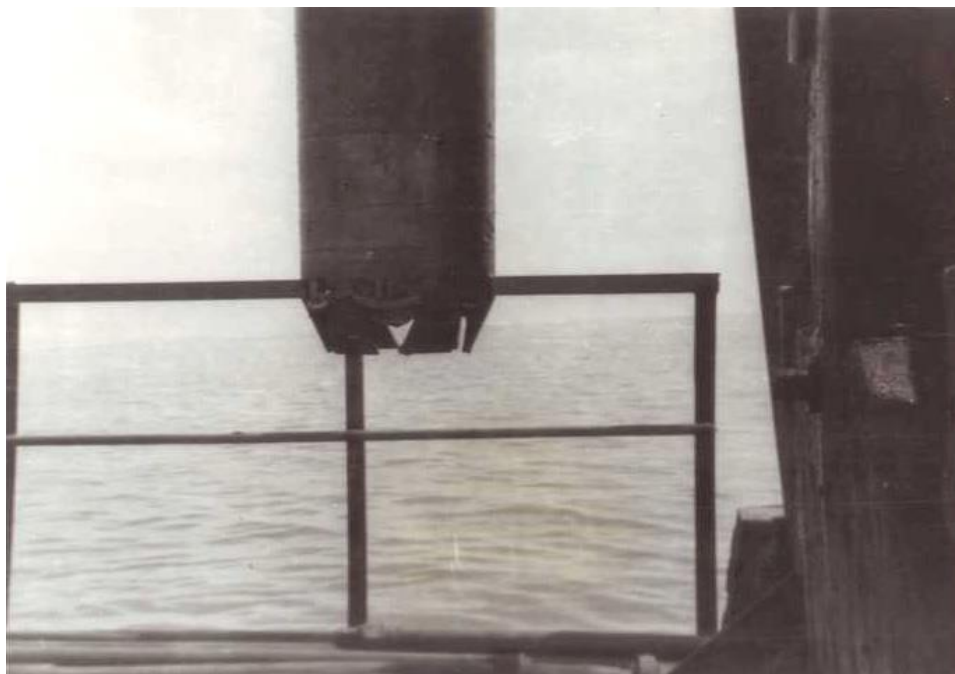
Грунтоотборник с отобранной пробой грунта и закрытой грунтоприемной камерой на палубе понтона
